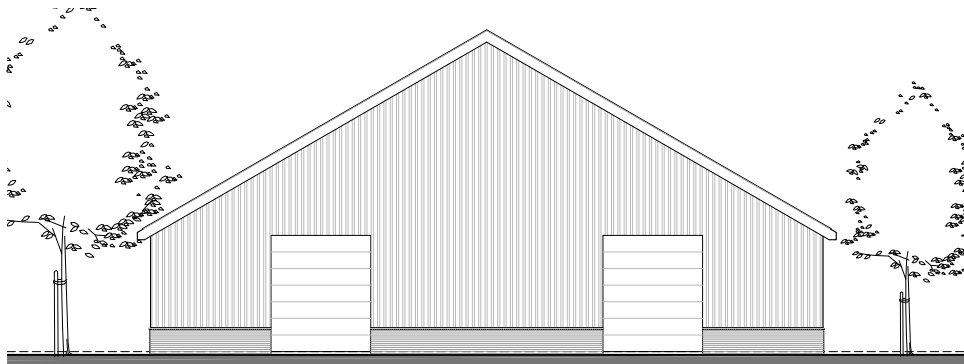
Achterzijde manegeschoor, volume wordt gebroken door overgang van materiaalgebruik (steen aan voorzijde, houtbekleding aan achterzijde)
